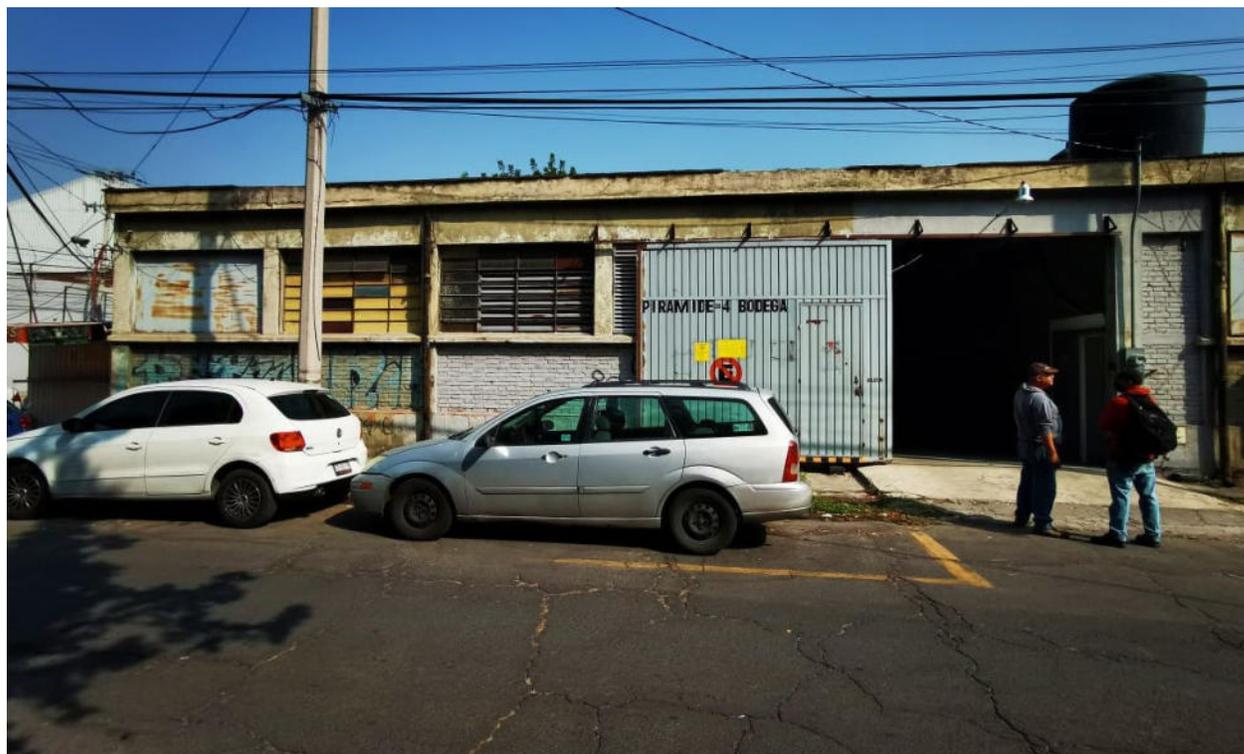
Entrada. La bodega que pretende utilizarse para construir el proyecto cuenta con zaguán corredizo metálico y está construida en su totalidad de ladrillos y cemento, además, cuenta con columnas y loza de concreto.
